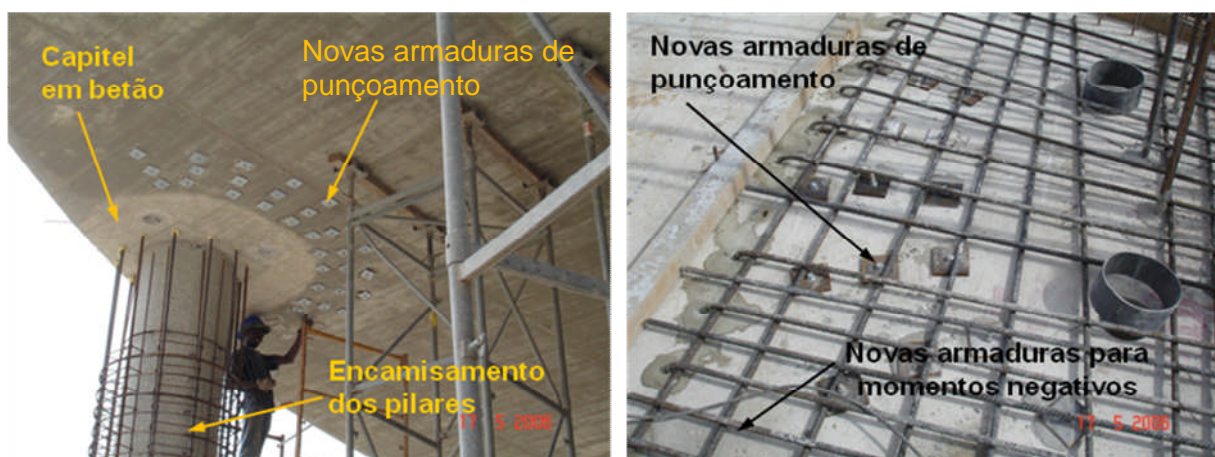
Inspeção às armaduras de uma laje fungiforme.
